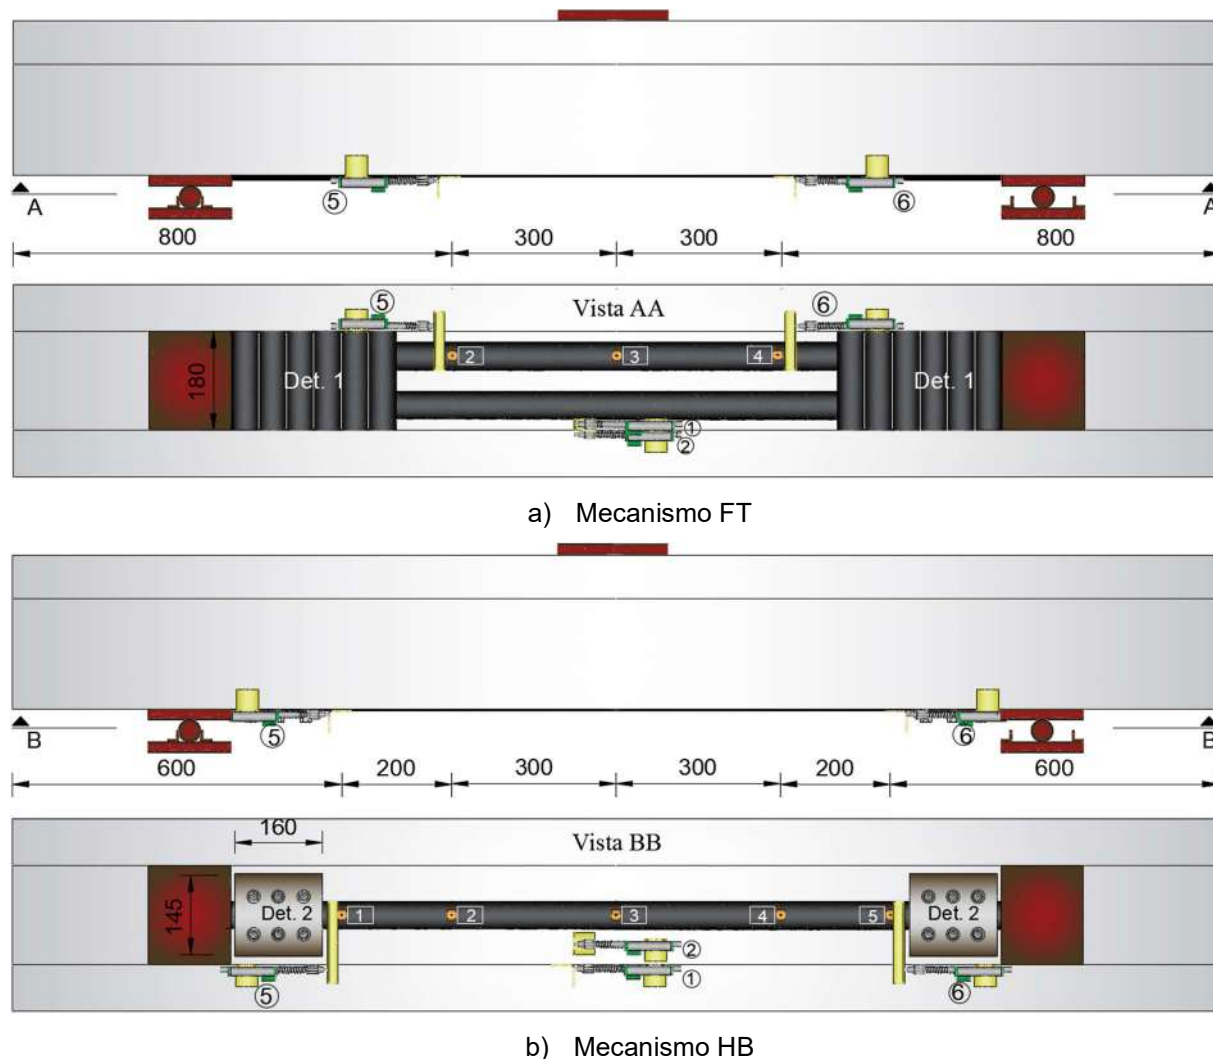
Posição dos extensômetros e dos potenciômetros no laminado (mm).
